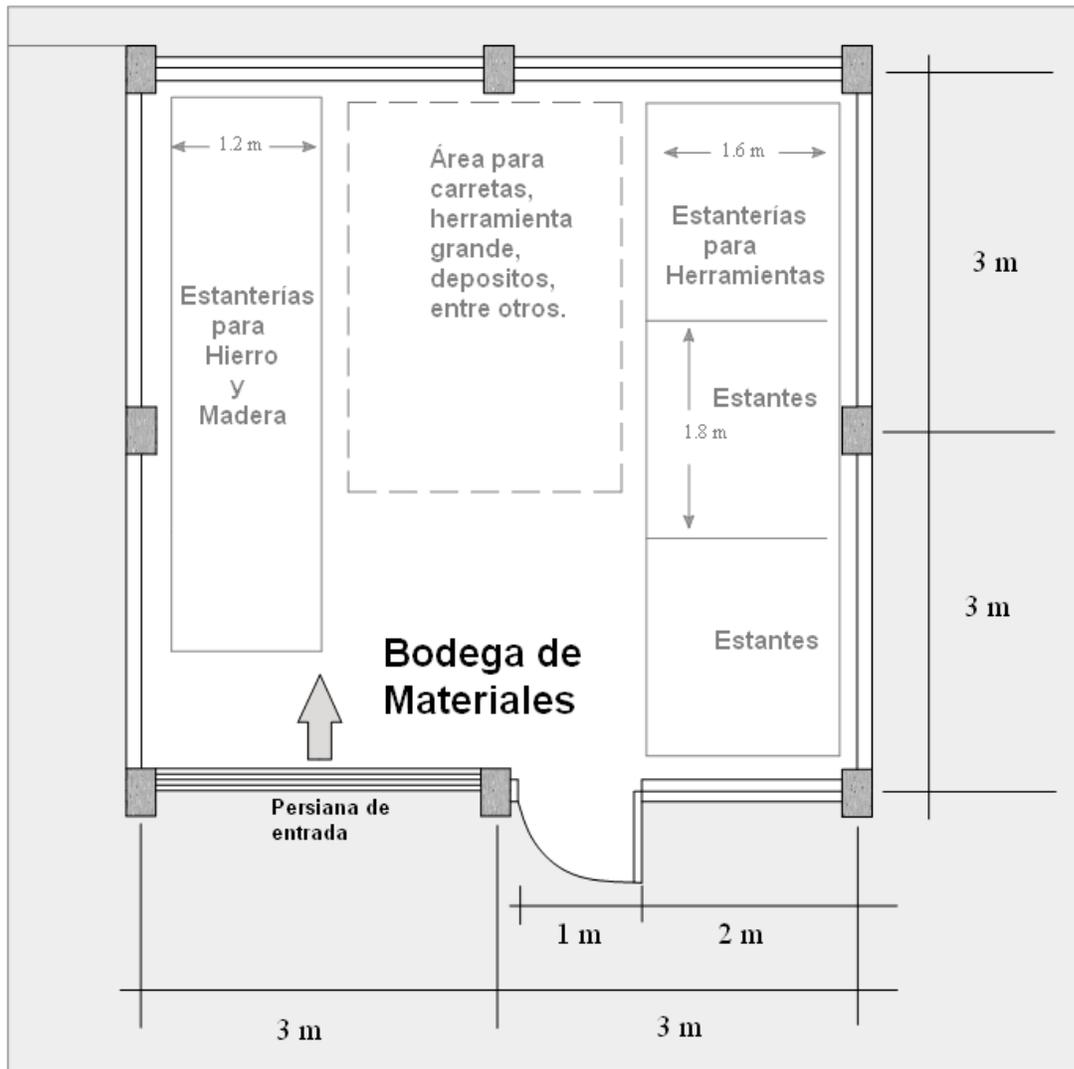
Vista frontal de bodega de materiales propuesta para Laboratorio de Concreto Armado
